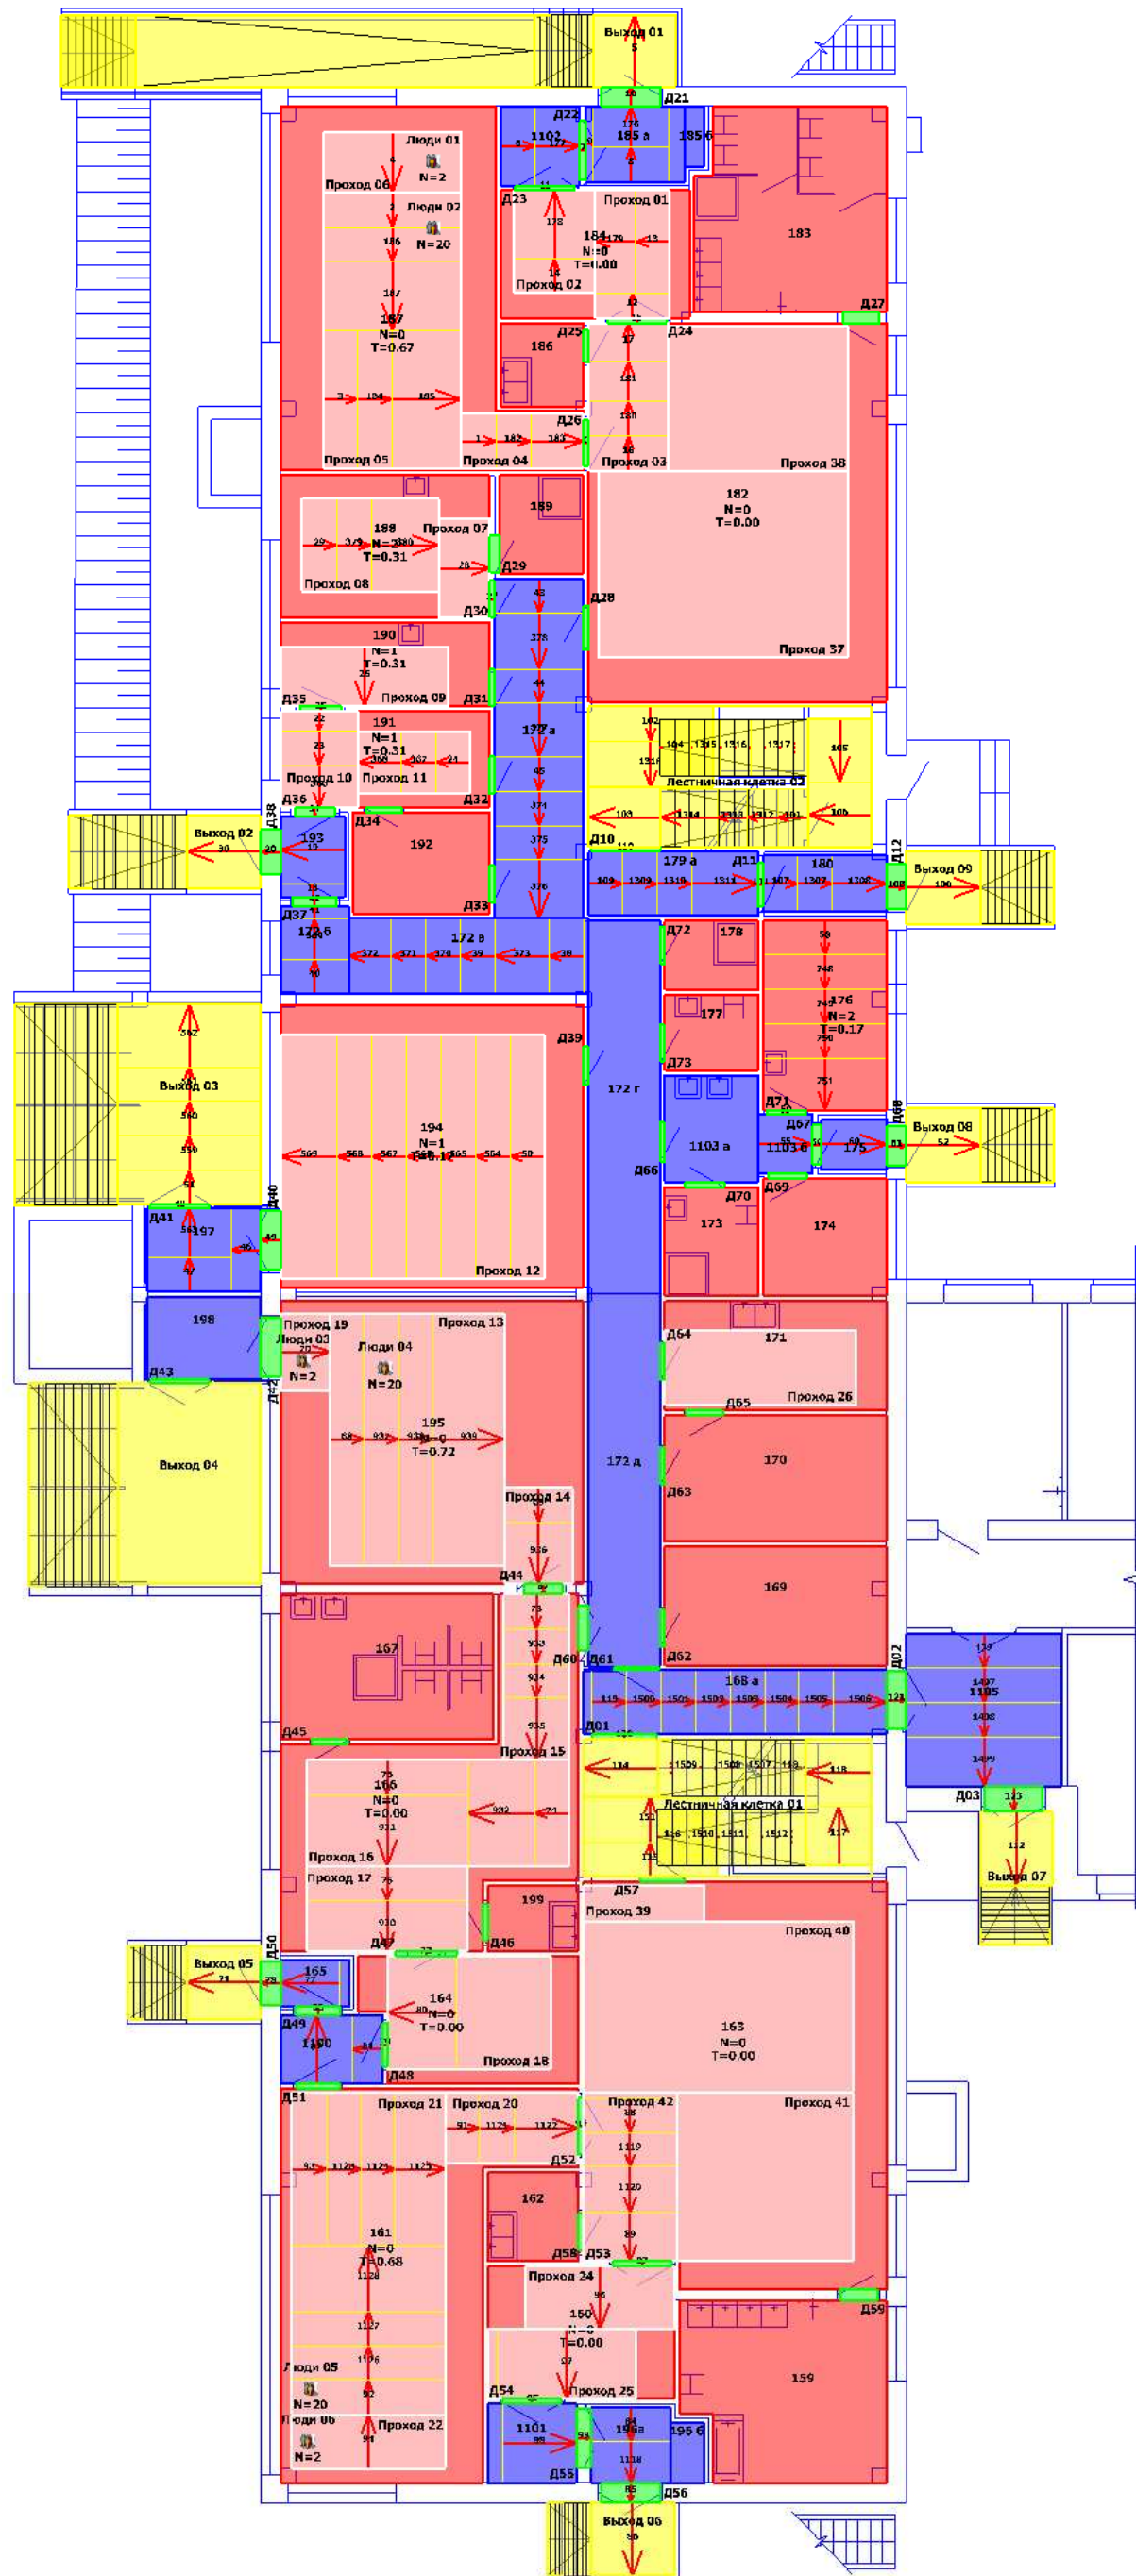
Схема разбиения на участки маршрутов эвакуации из помещений 1-го этажа здания Детского сада на 60 мест с начальной школой на 100 учащихся (Сценарий 01)
